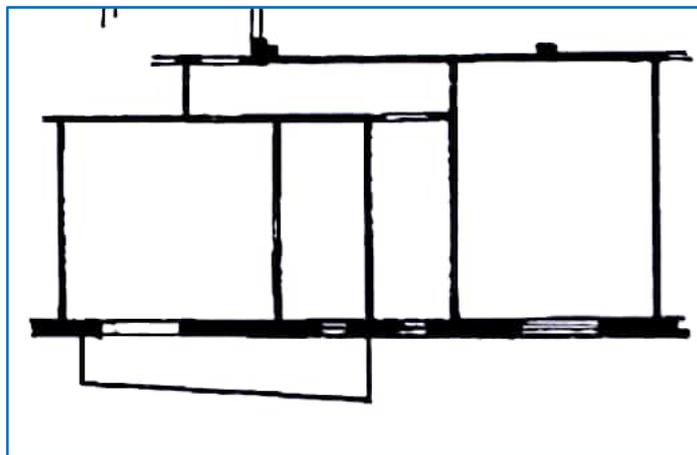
estratto planimetria catastale dell'appartamento - sub. 13
